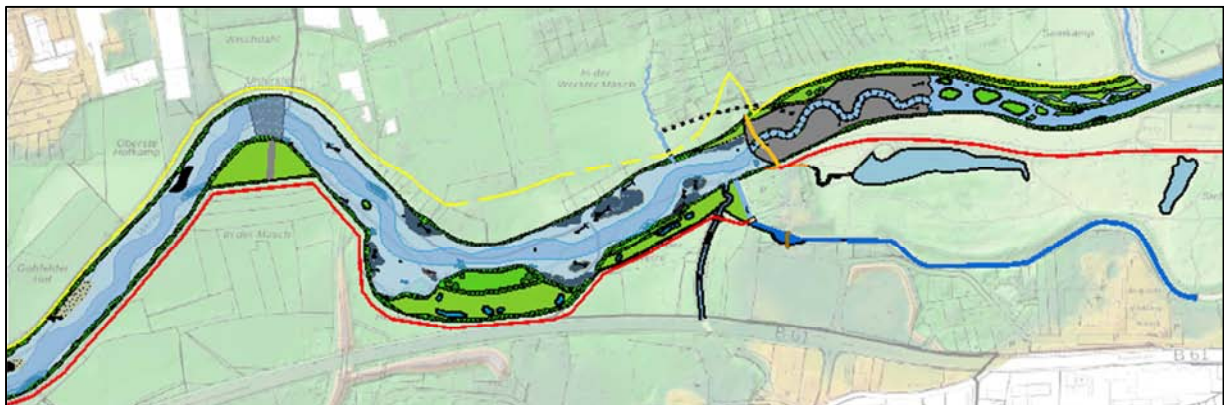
Lageplan Planung mit Rad-/Fußwegeverlauf in rot, unterer Bereich
